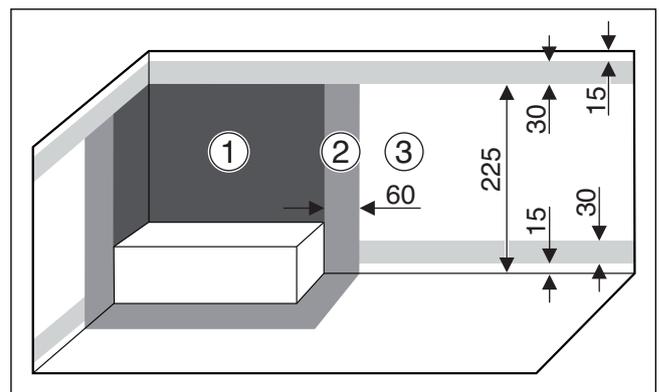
Installationsbereiche im Bad nach DIN VDE 0100-701
